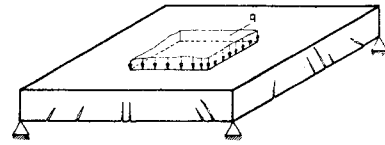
Gerissene Stahlbetonplatte (Zustand II).
